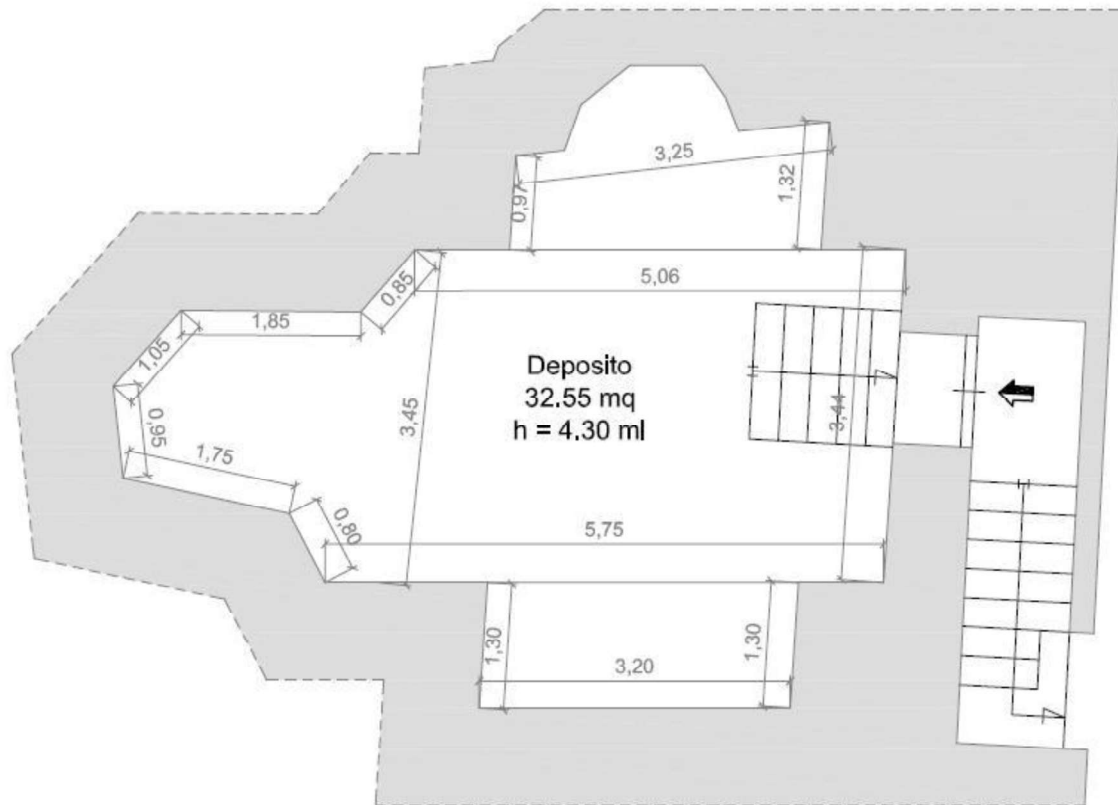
Planimetria Stato di Fatto Deposito Piano Interrato.
